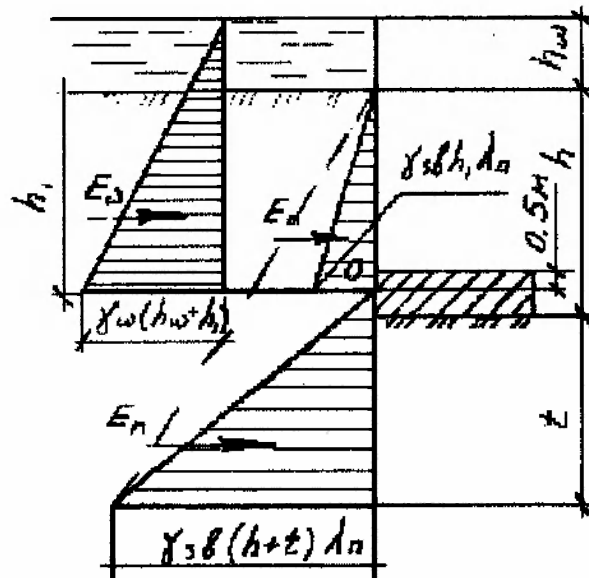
Схемы к расчету свободно стоящей шпунтовой стенки в несвязных грунтах с подводной тампонажной подушкой:
